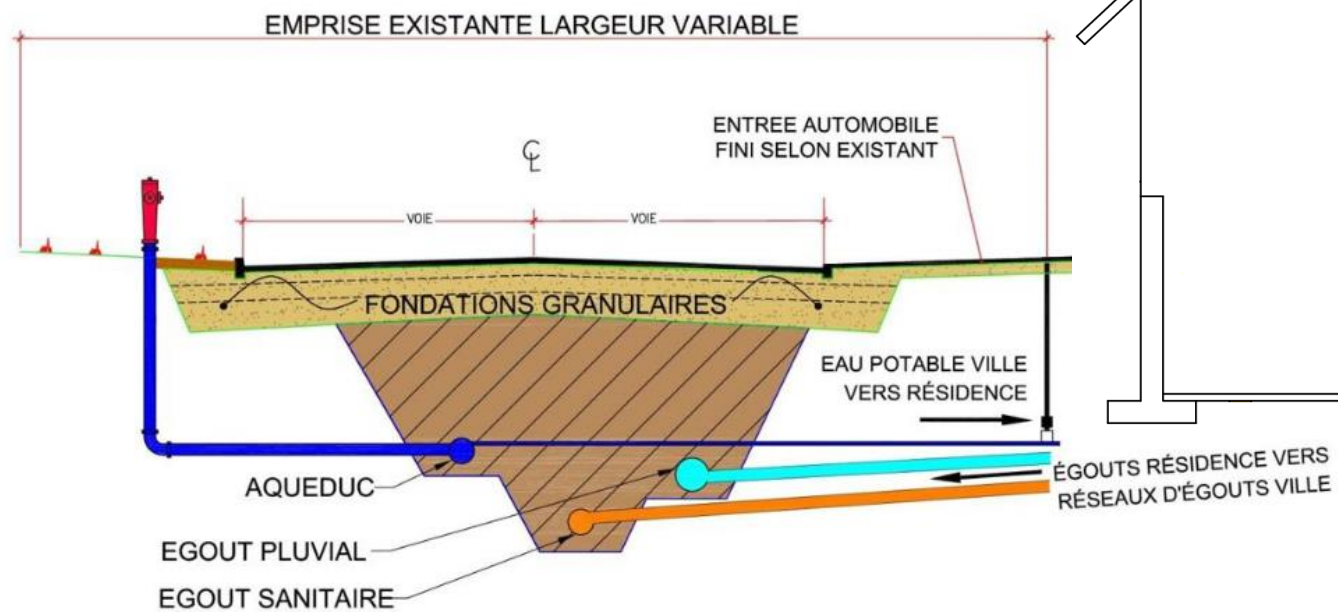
FIGURE: RECONSTRUCTION DE LA CHAUSSÉE
